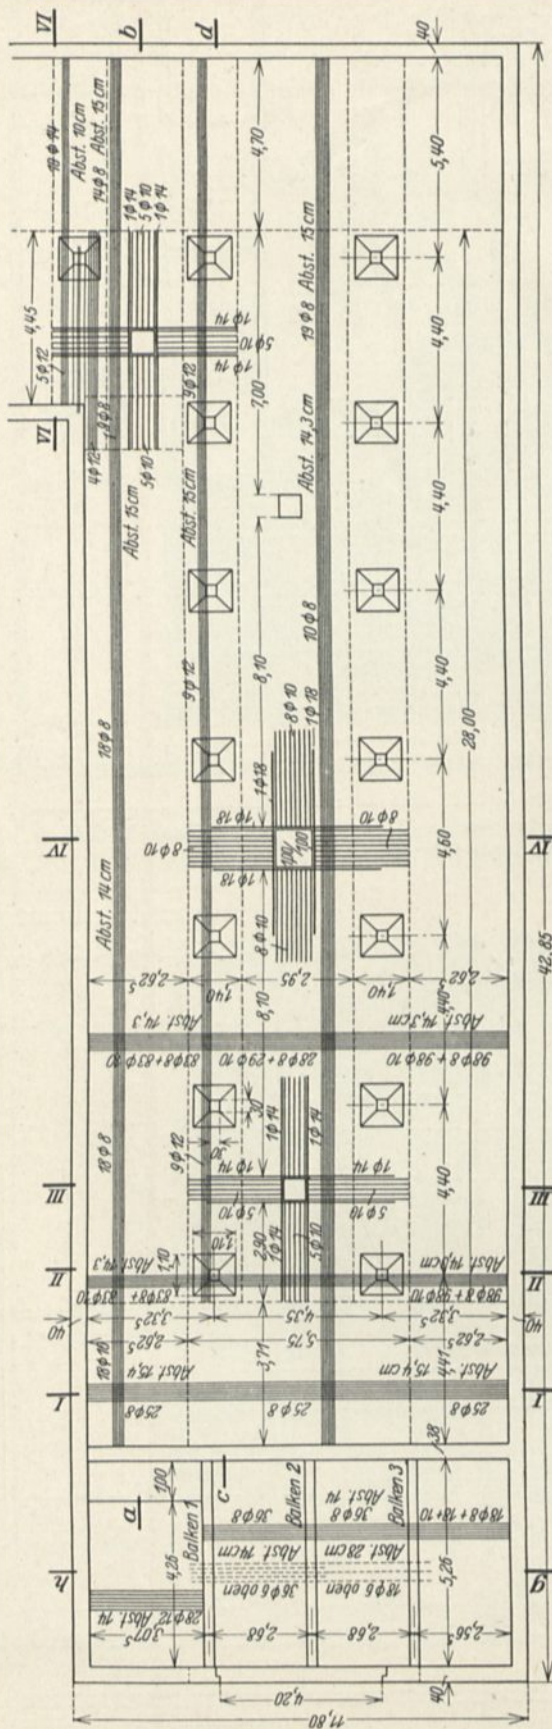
Stallgebäude Schloß Haag b. Geldern. Bewehrung der Stalldecke.
